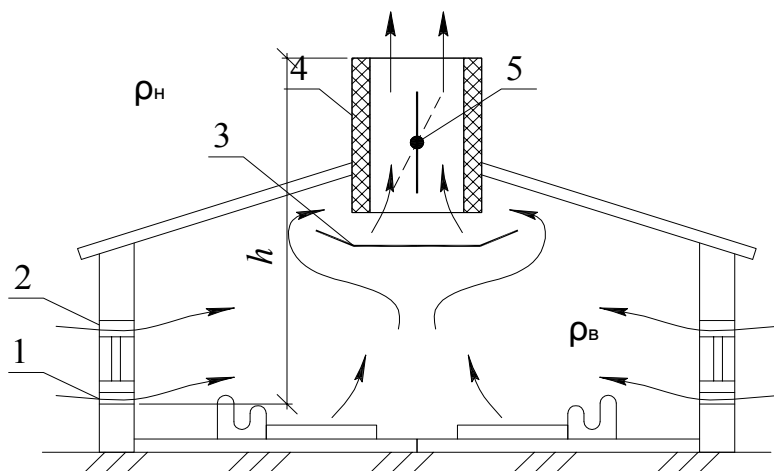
Схема шахтной вентиляции: 1, 2 – подоконные или надоконный приточные проемы; 3 – поддон; 4 – шахта; 5 – дроссель-клапан
